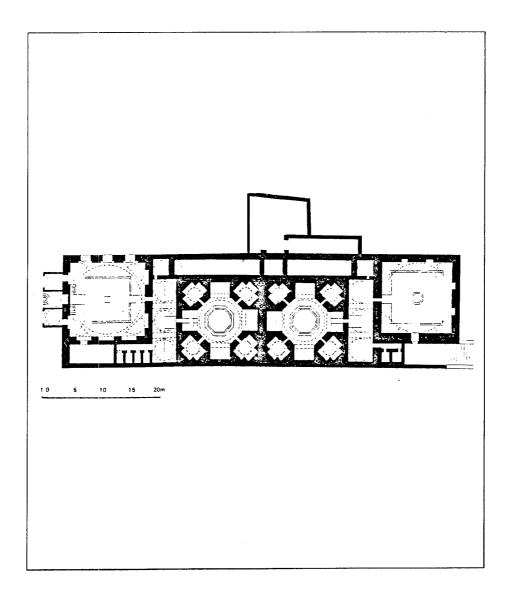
مسقط أفقي لحمام Tahta kale بأدرنة (عن : إيفردى) .
